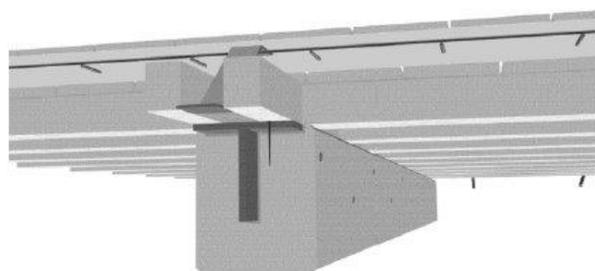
Reforço de viga através da colocação de chapa vertical soldada a chapa horizontal na face superior da viga (Mariani, 2004)
